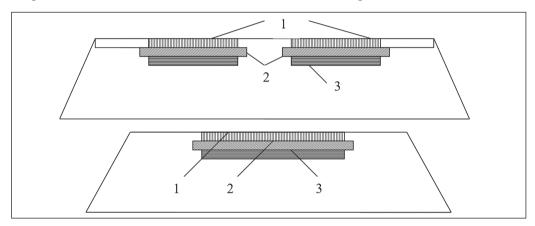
Реконструкция асфальтобетонного покрытия на автодорогах I и III технических категорий без полного вскрытия дорожной одежды: 1 – новое асфальтобетонное покрытие; 2 – монолитный «отражающий экран» из асфальтового гранулята; 3 – основание существующей дорожной одежды.
